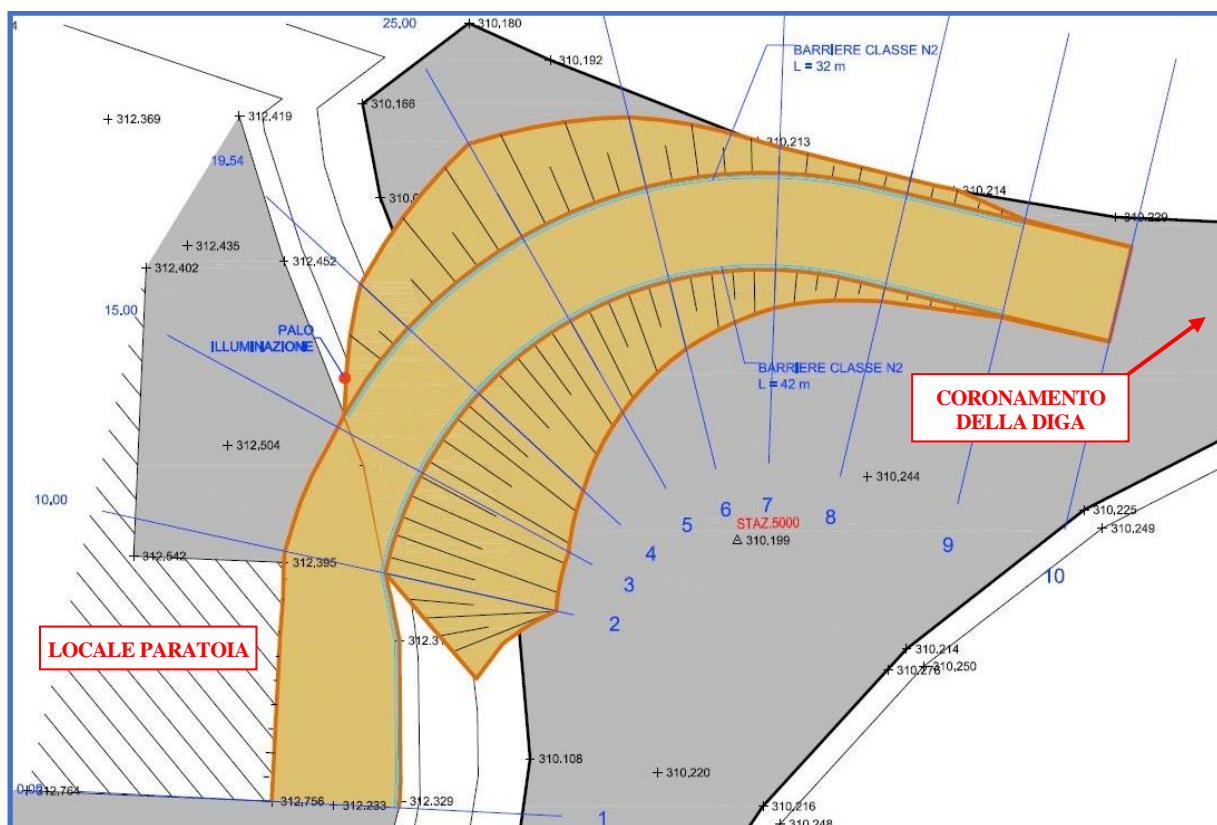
Zona intervento 4 – Planimetria della pista provvisoria
